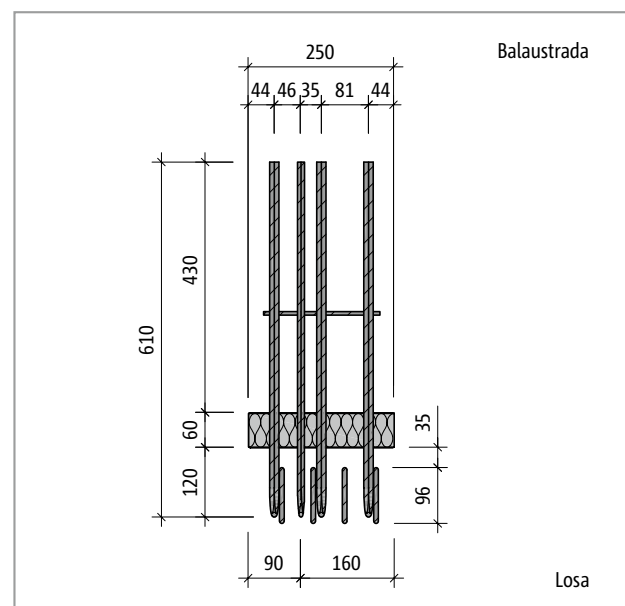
Schöck Isokorb® T tipo A-MM2-X60: Vista del producto
